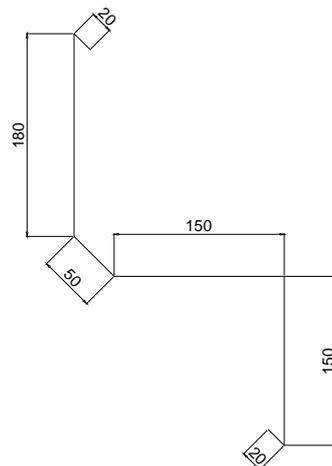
Relevé en tête sur mur en héberge (épaisseur 1 mm)
